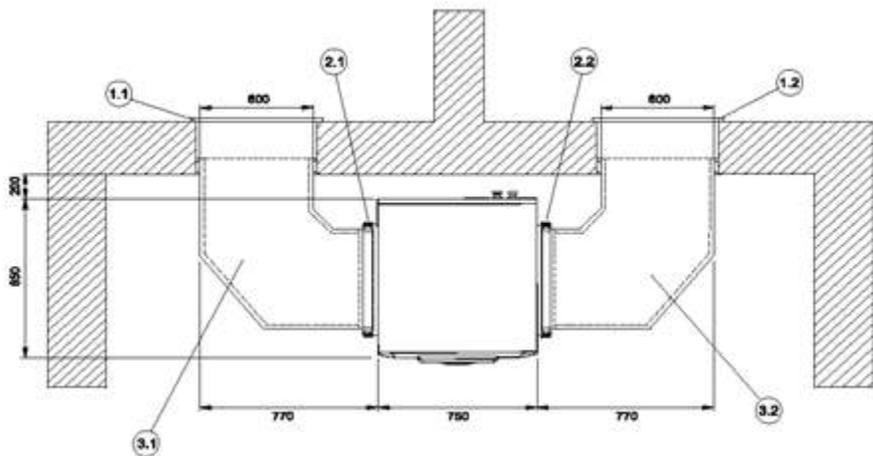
Installazione a parete con condotto dell'aria lato aspirazione e lato scarico - vista dall'alto
